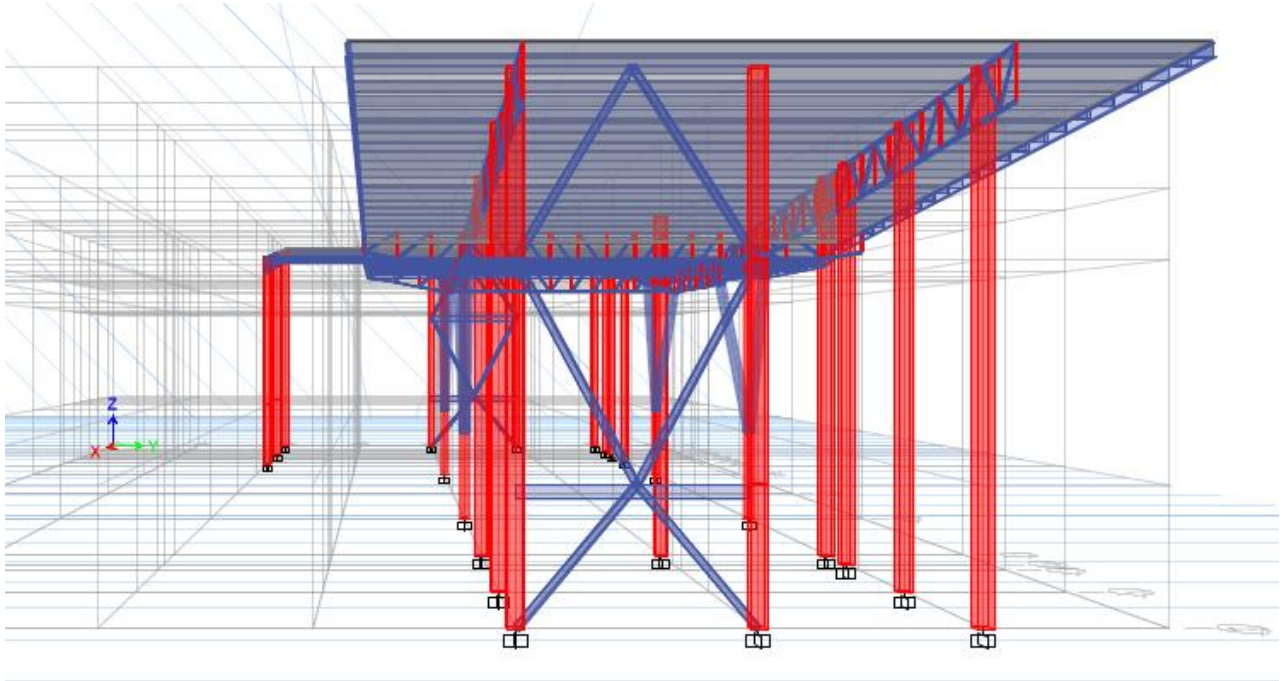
Elevación Y-Z 3D Estructura de armaduras.
